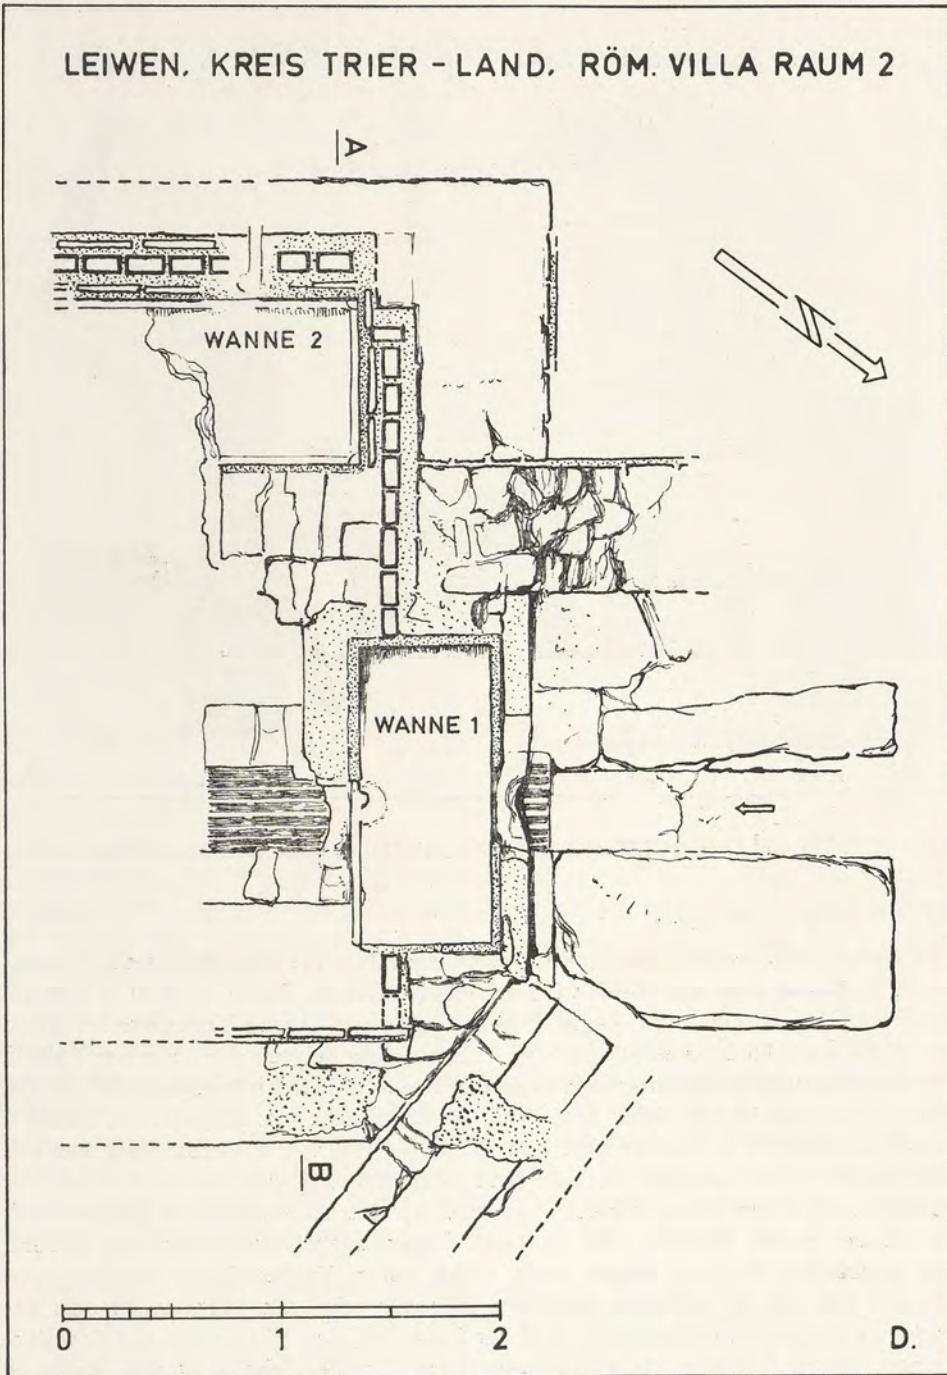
Villa von Leiwien. Raum 2 mit den eingebauten Badebecken 1 u. 2; Grundriß
